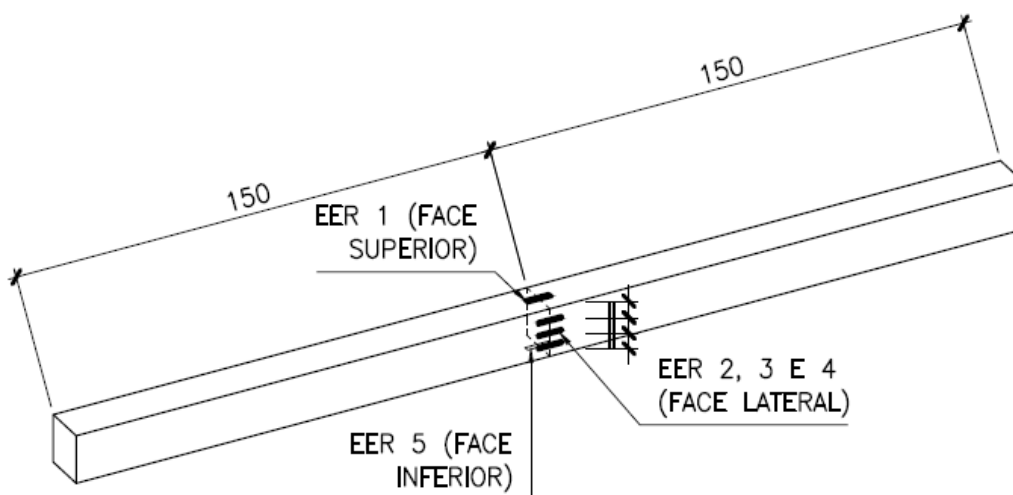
Posicionamento dos EER nas vigas de madeira – tipo 2 (dimensões em cm).
